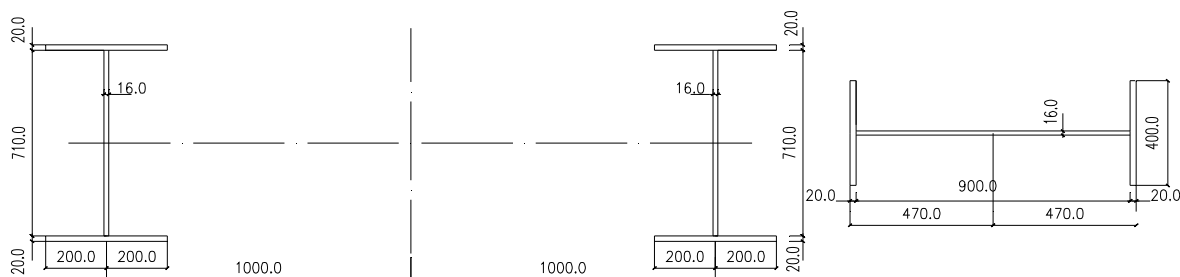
Поперечное сечение подкрановой и надкрановой частей средней колонны
